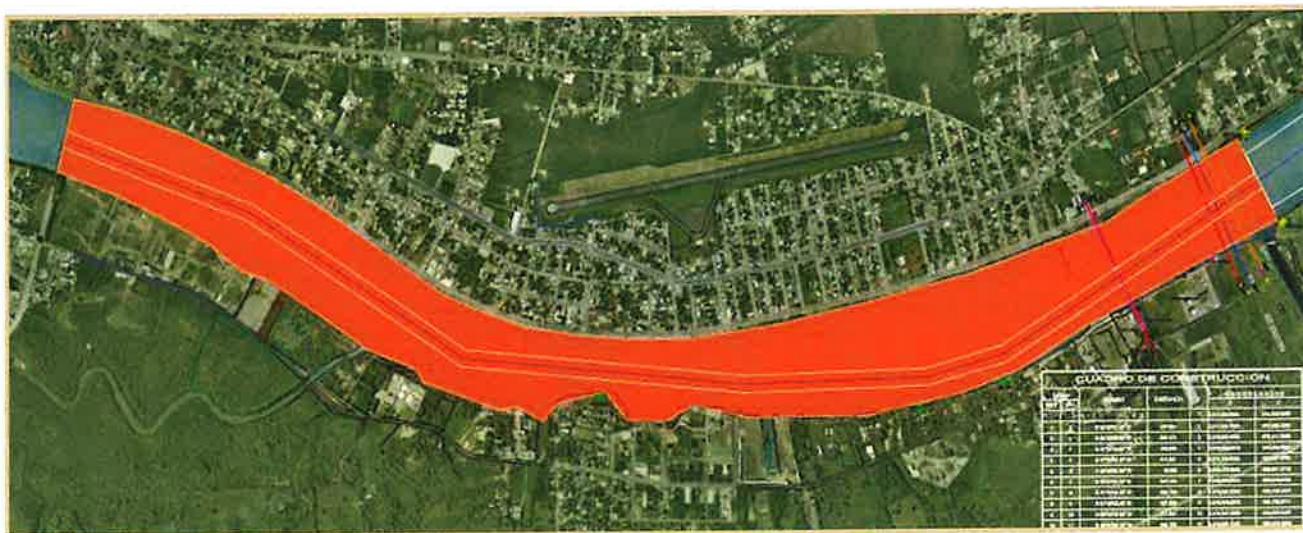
Vista en Planta del Canal de Navegación Aguas Arriba entre los cedramientos (5+431 Al 10+460).
